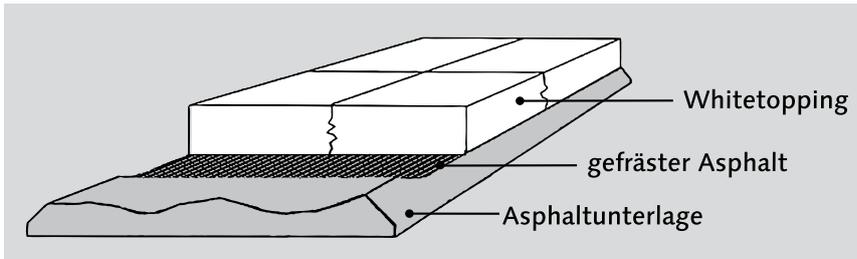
Systemskizze Whitetopping „Beton auf Asphalt“
